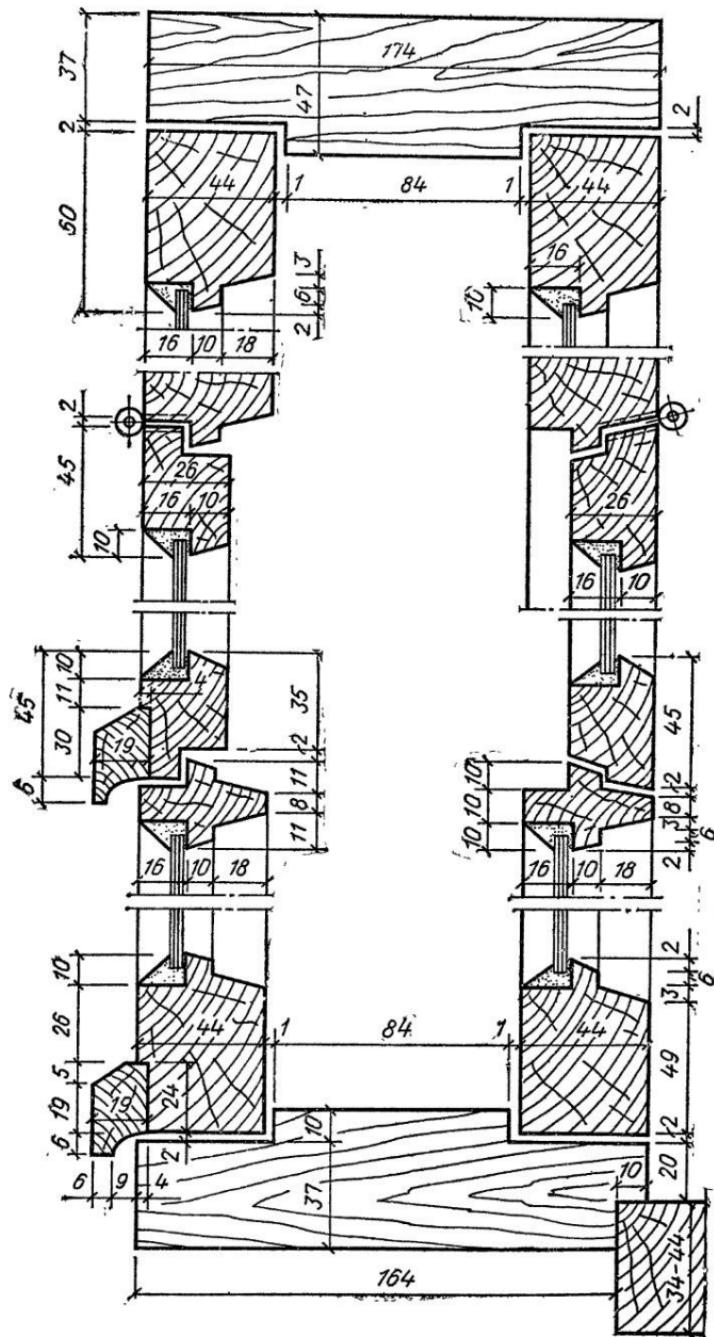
Детали оконного блока без наплава (вертикальный пазы)
